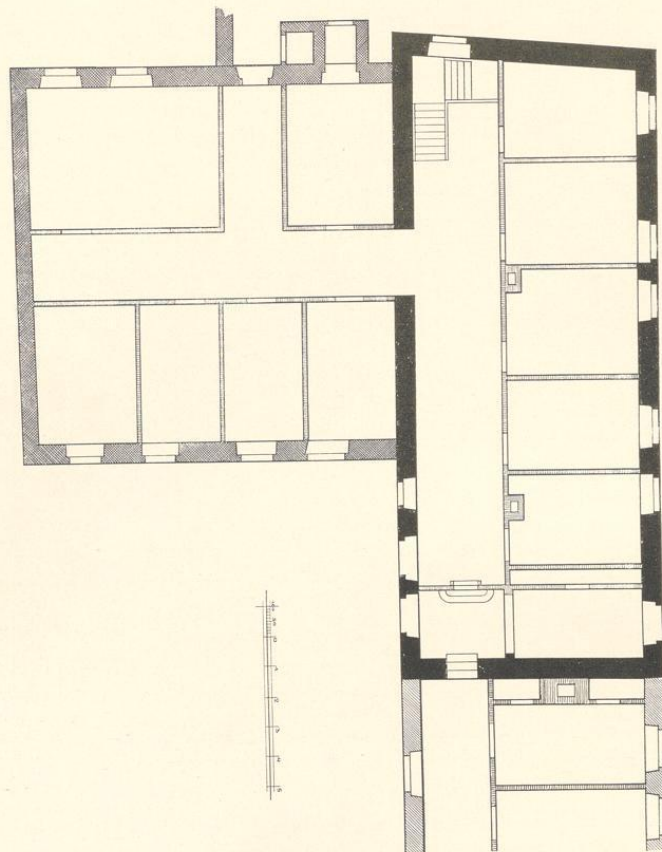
Grundriß der älteren Teile des Magdalenenhospitals Ludgerstraße 25/26
